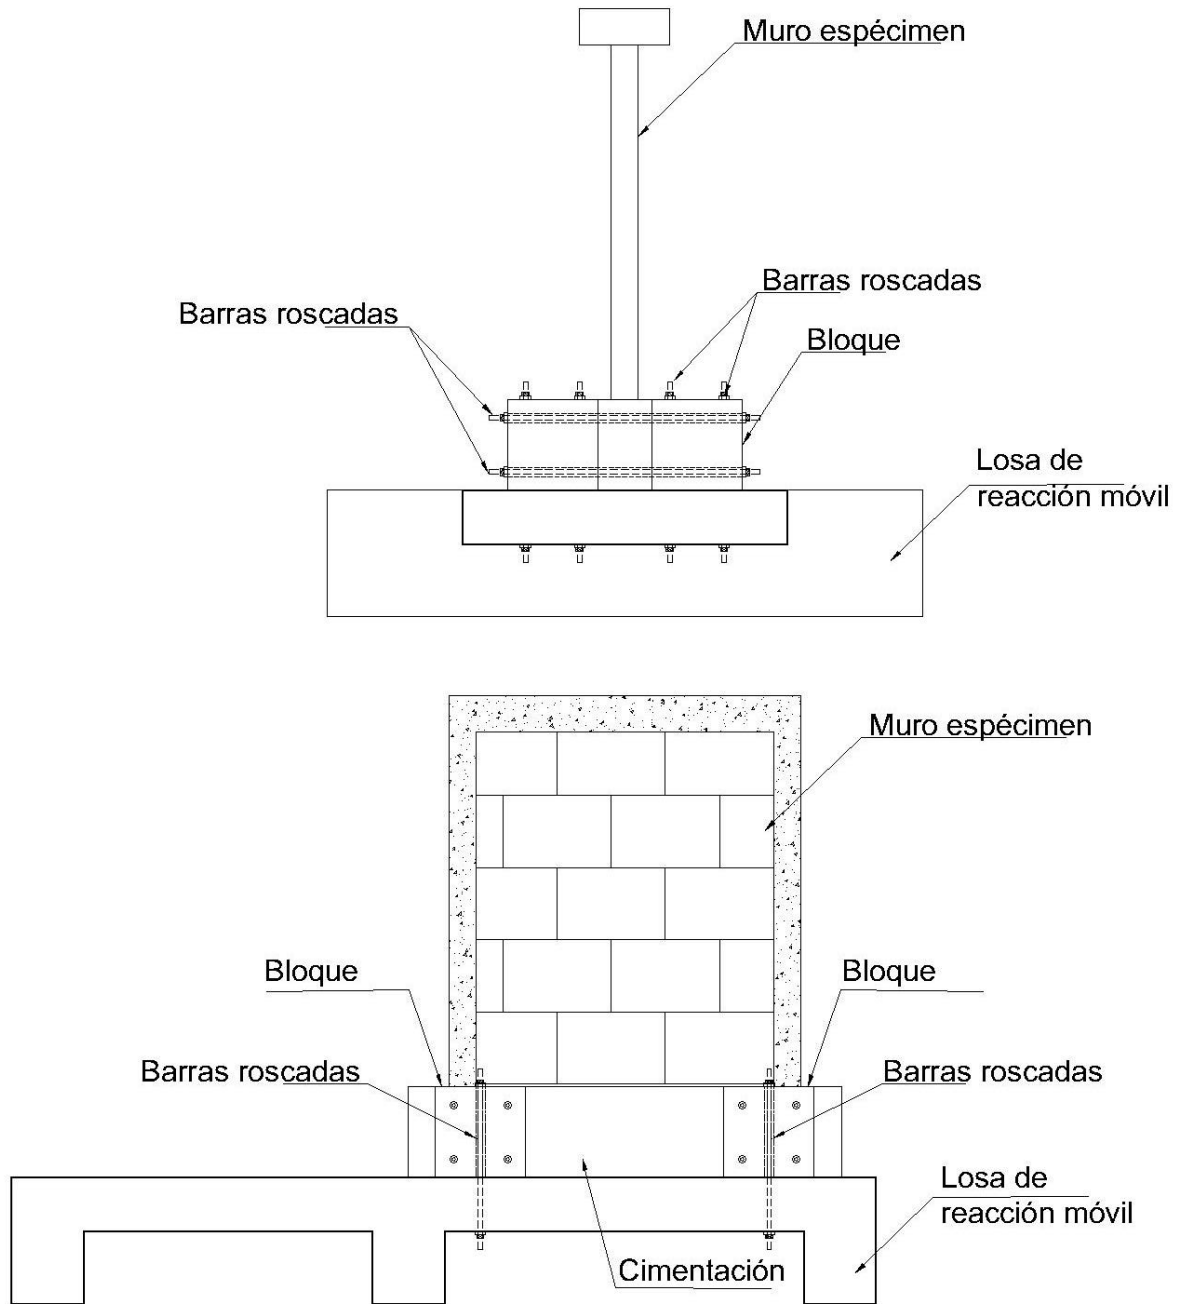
Anclaje de muros espécimen a losa de reacción móvil.
